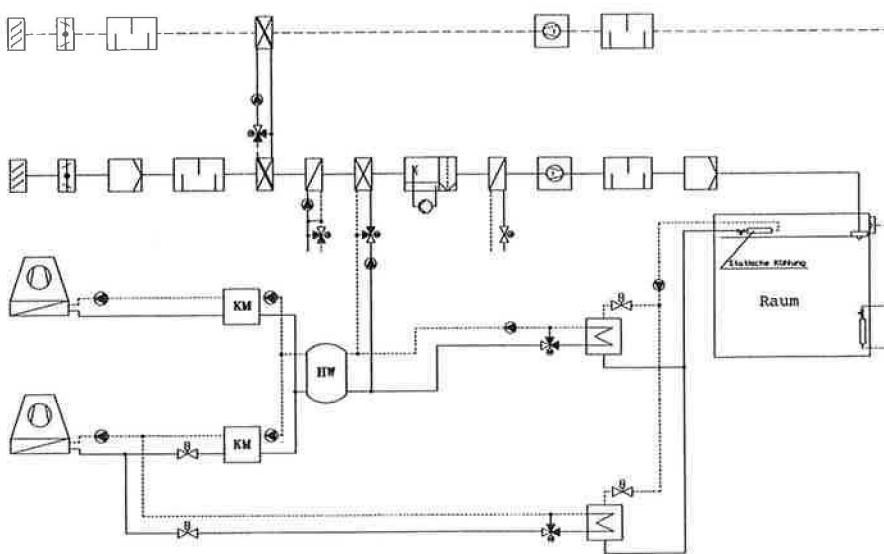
Anlagenschema Wasserkühldecke mit Quelllüftung (KVS-Anlage)
